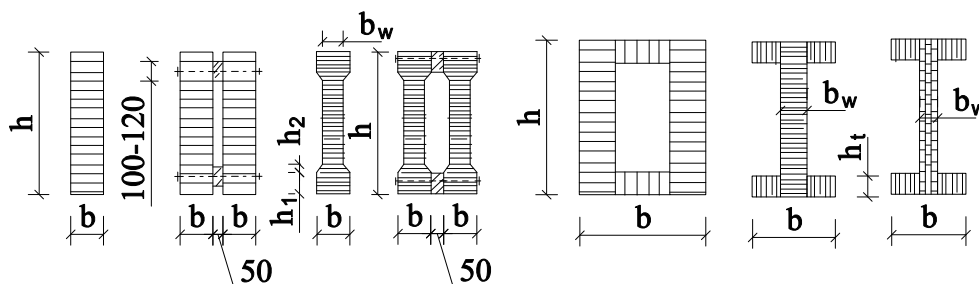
Схемы поперечных сечений балок из слоистой клееной древесины
